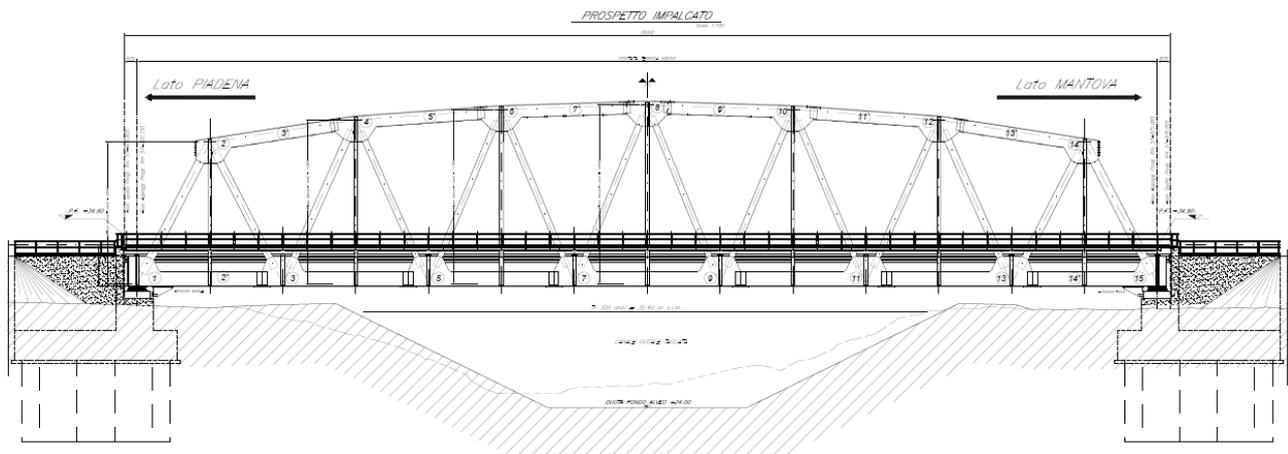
VI01: Prospetto longitudinale (NM2503D09BZVI0109001A)
